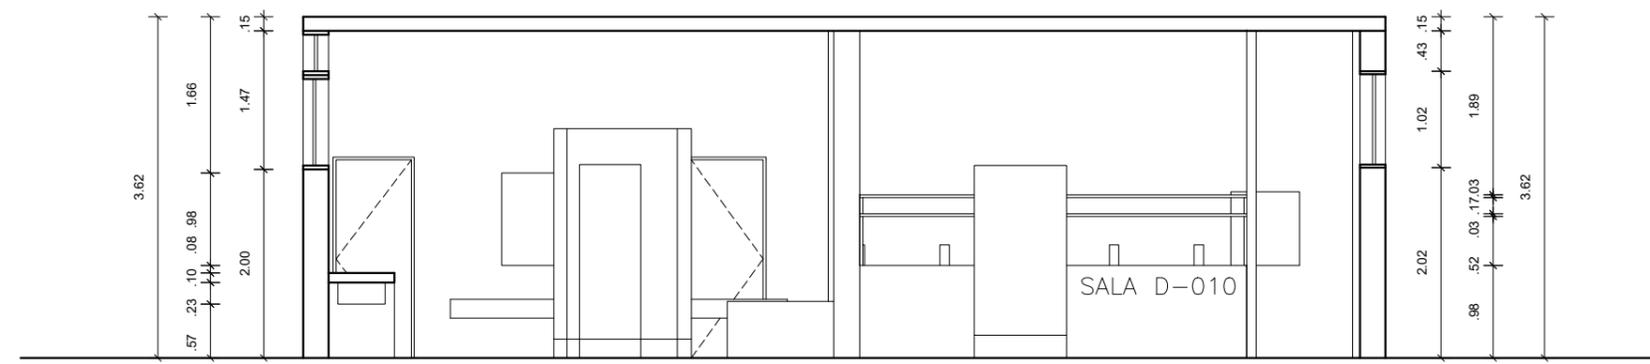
Proposta de Requalificação - Cortes Transversais 01
